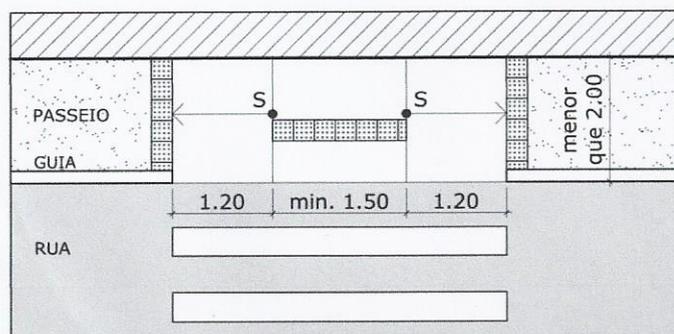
Rebaixamento de meio-fio para calçadas com largura inferior a 2,00 metros
